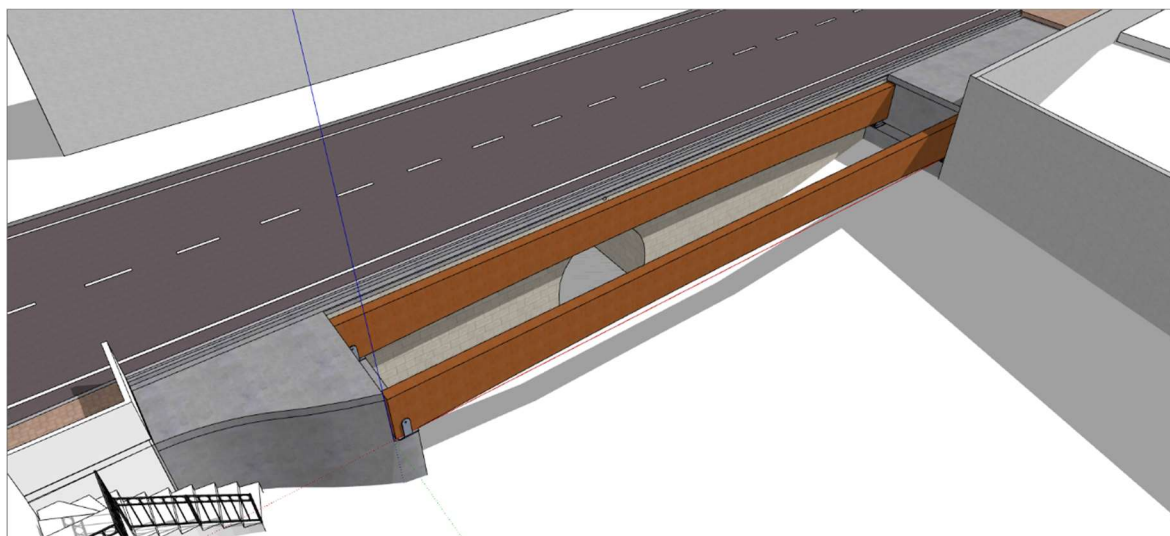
Schizzo delle spallette laterali di appoggio della passerella
